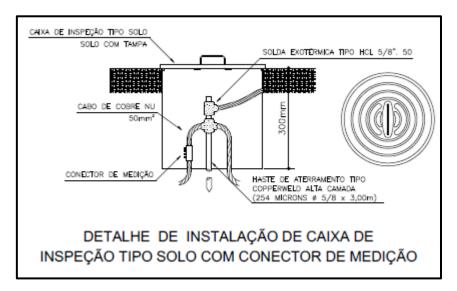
Detalhe de instalção de caixa de inspeção tipo solo com conector de medição
